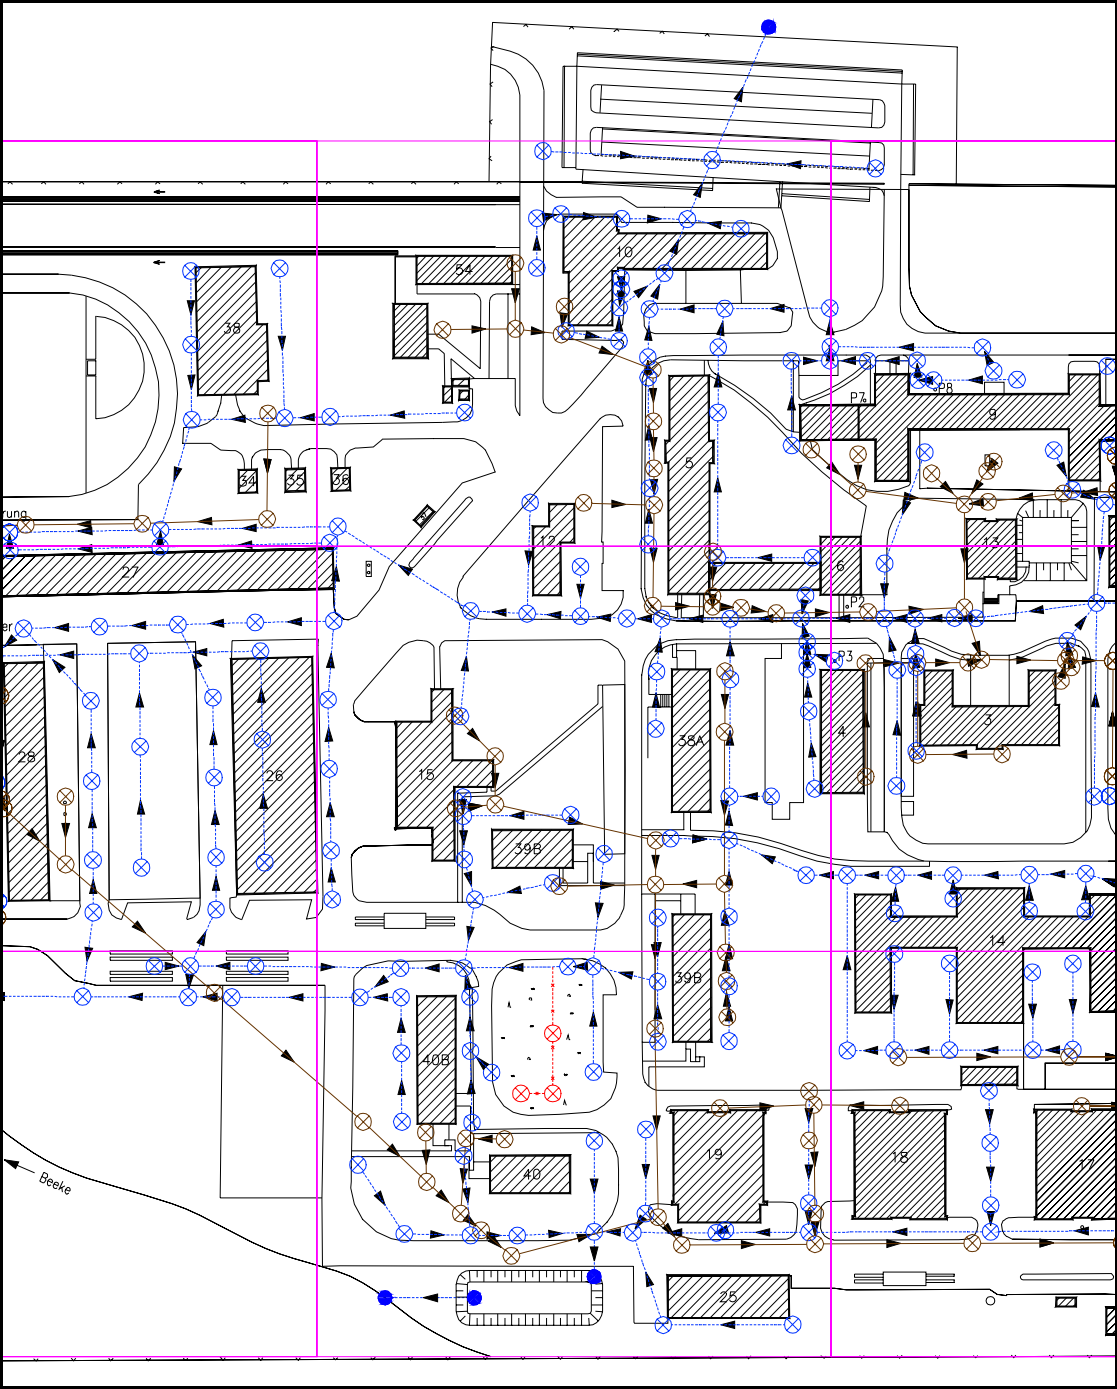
2 Beispielplan: Übersichtslageplan "Bestand"
